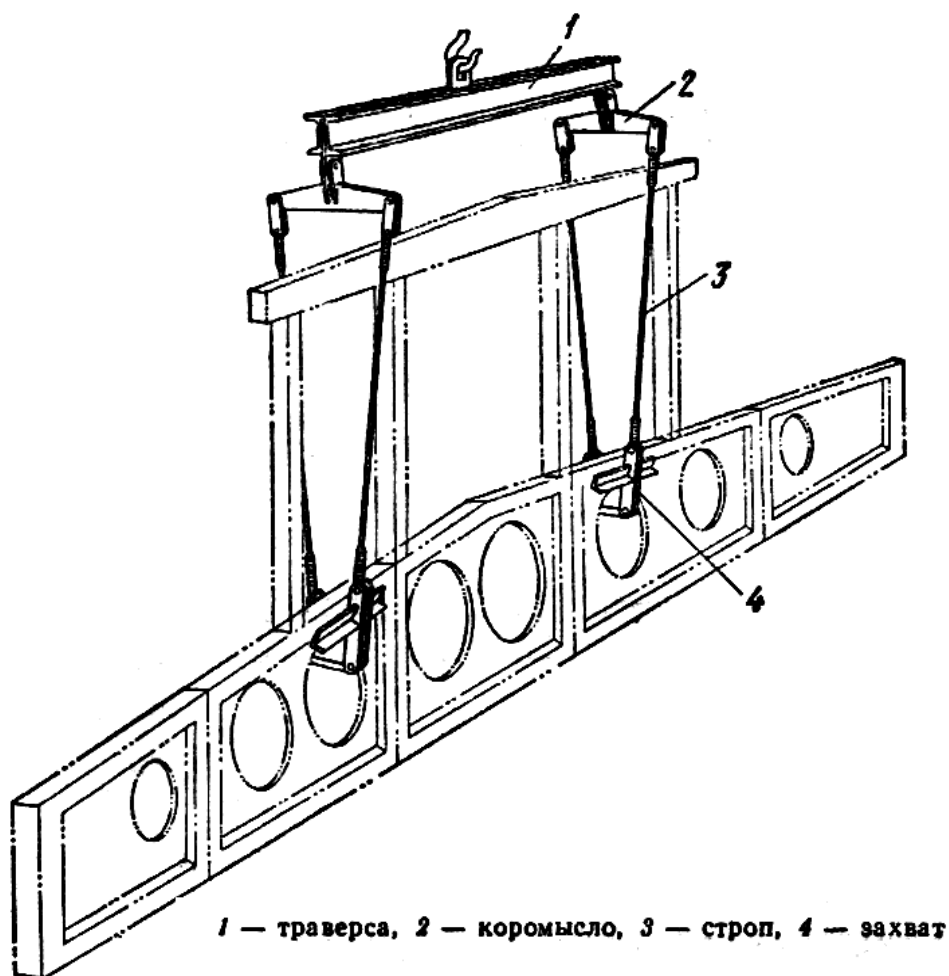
Траверса для подъема балок с фонарем и ферм
